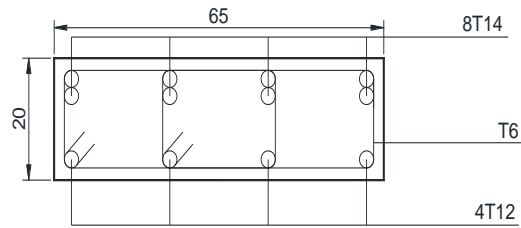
Coupe longitudinale d'une poutre noyée principale 65x20cm (bâtiment R+3)
